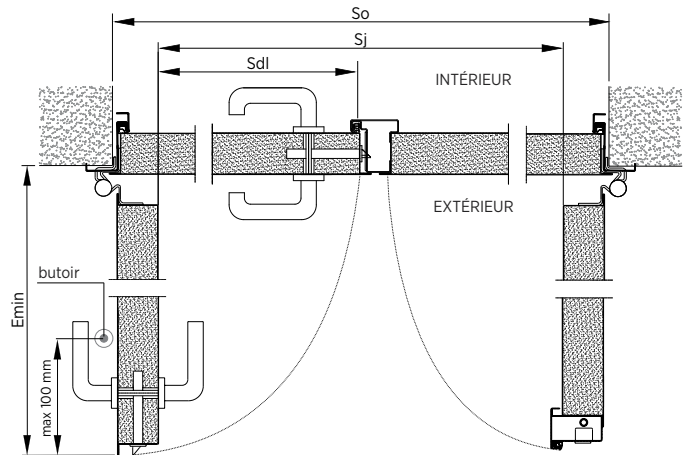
Pose devant la baie – bloc-porte à deux vantaux – bâti angulaire sans rupture de pont thermique – coupe horizontale
